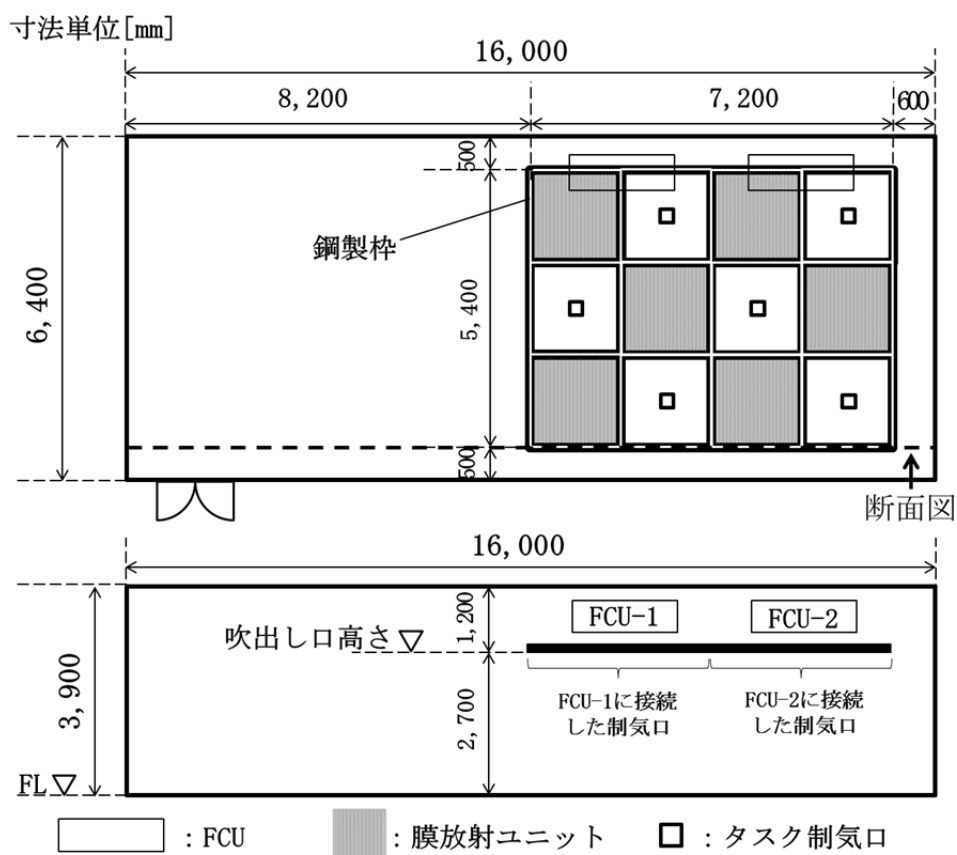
実験室概要 (上: 平面図、下: 断面図)
